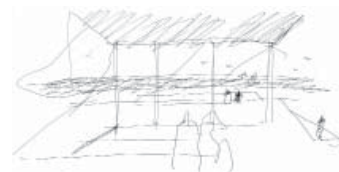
Entre Catedrais – Arquitecto Campo Baeza – Croquis de concepção.
